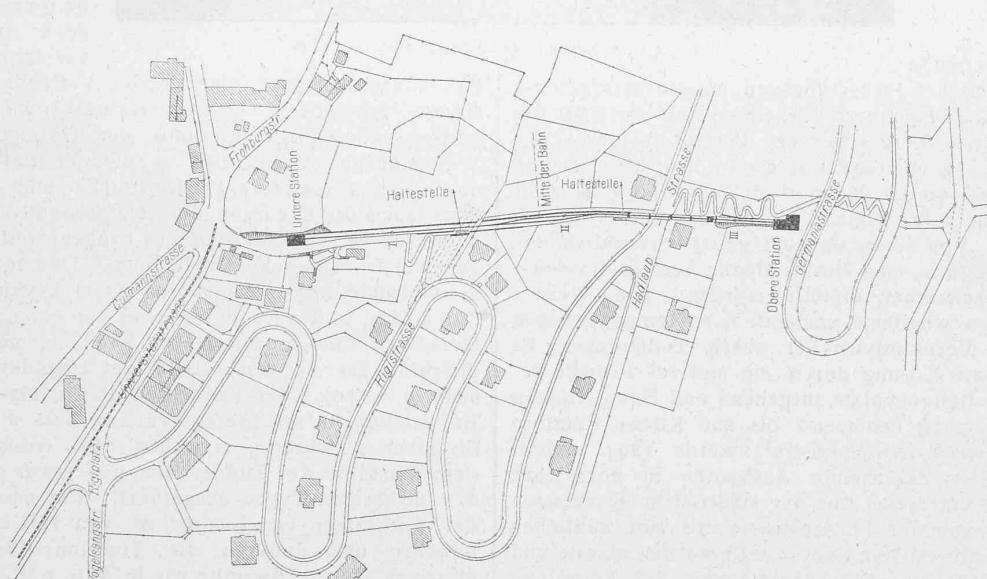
Lageplan des Rigiviertels und der Drahtseilbahn. — Masstab 1:4000.
